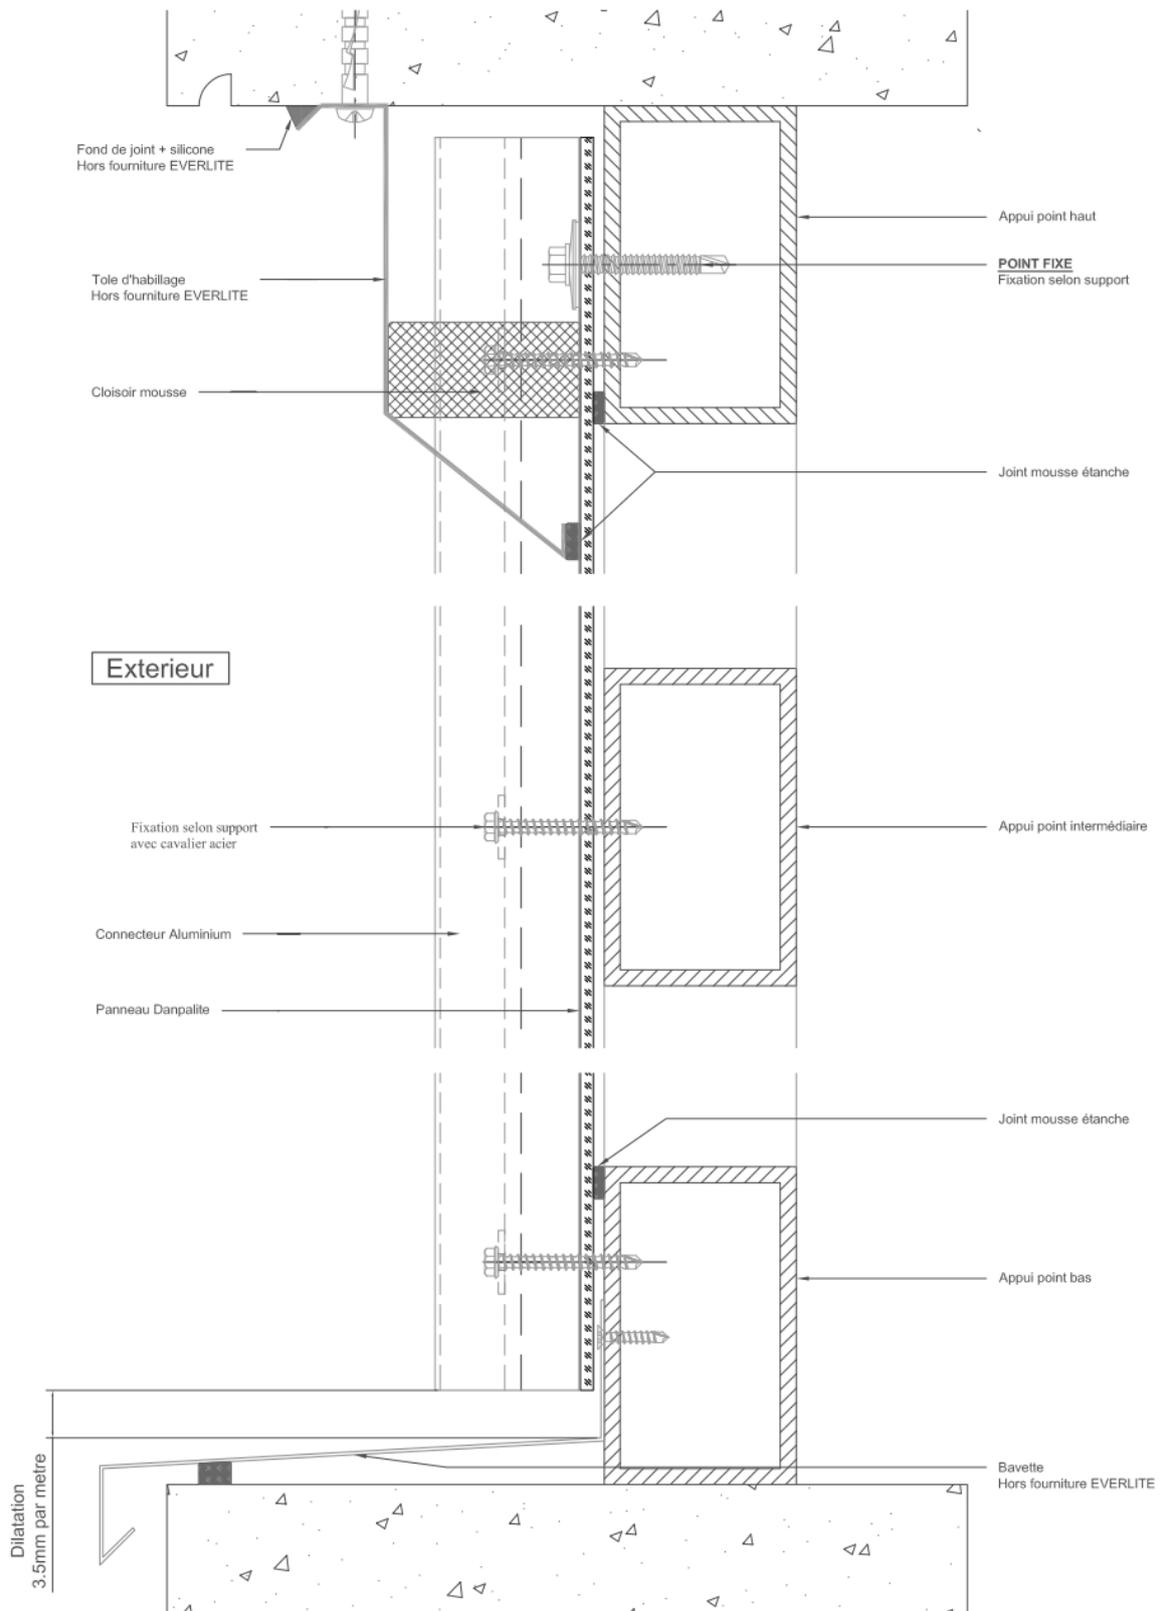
Système DANPALITE Façade / SHED - Coupe verticale
